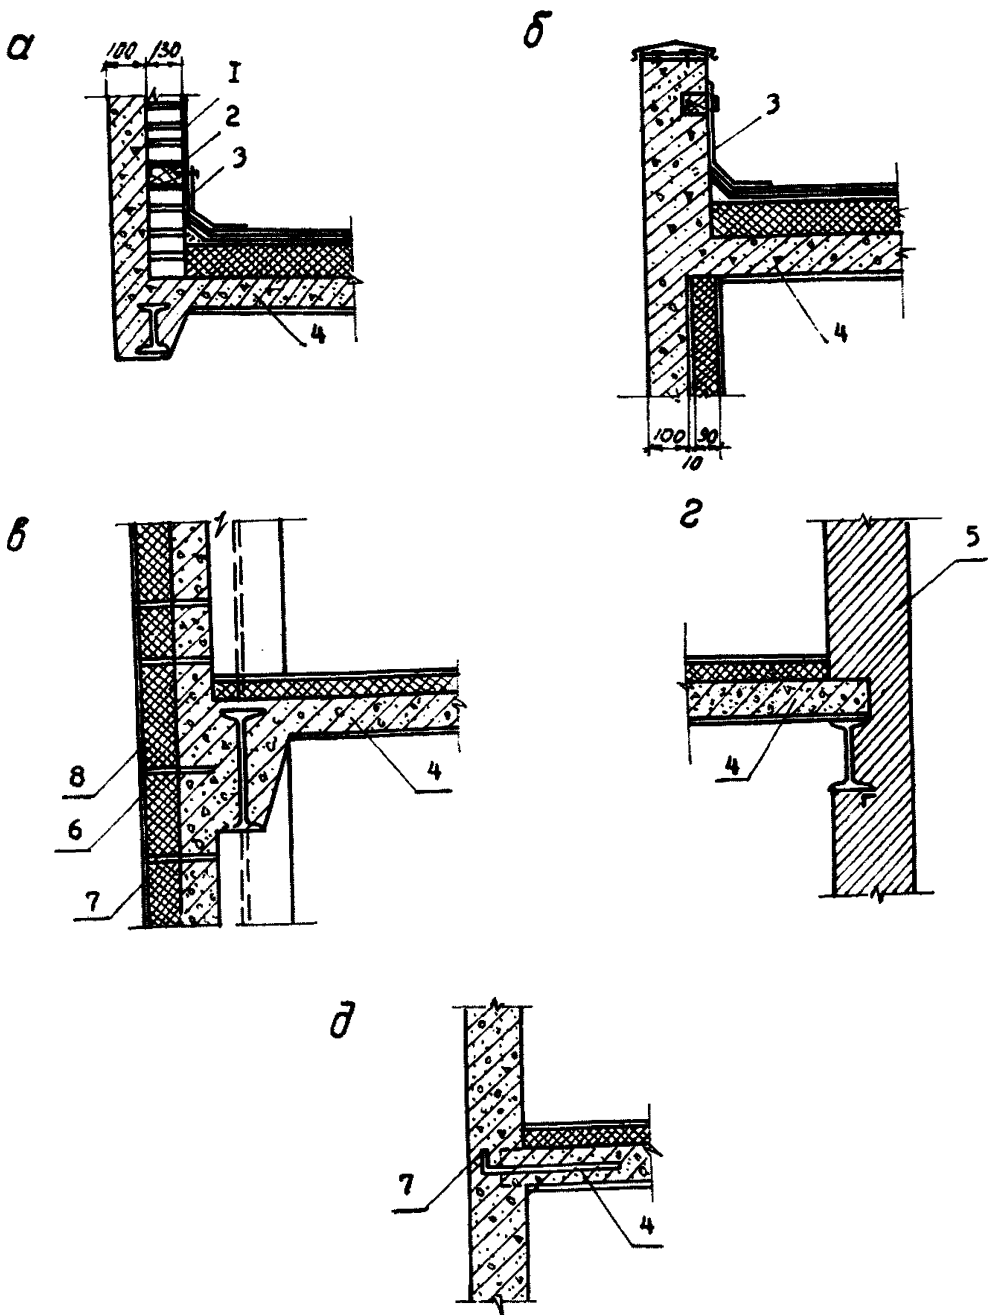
Герметизация мест сопряжения монолитных железобетонных конструкций перекрытий и покрытий со стенами:
